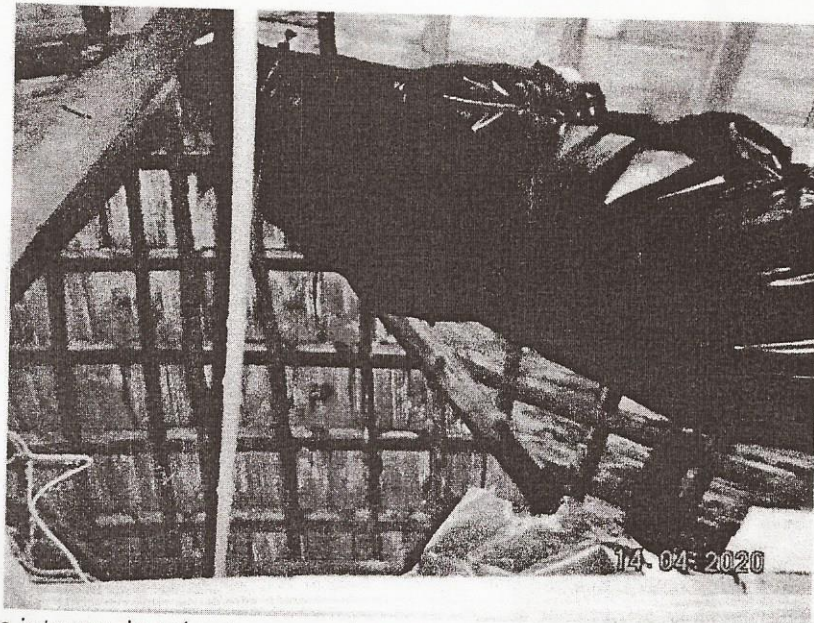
Detalhe interno da cobertura com destaque pontos de infiltração com a colocação de lona
